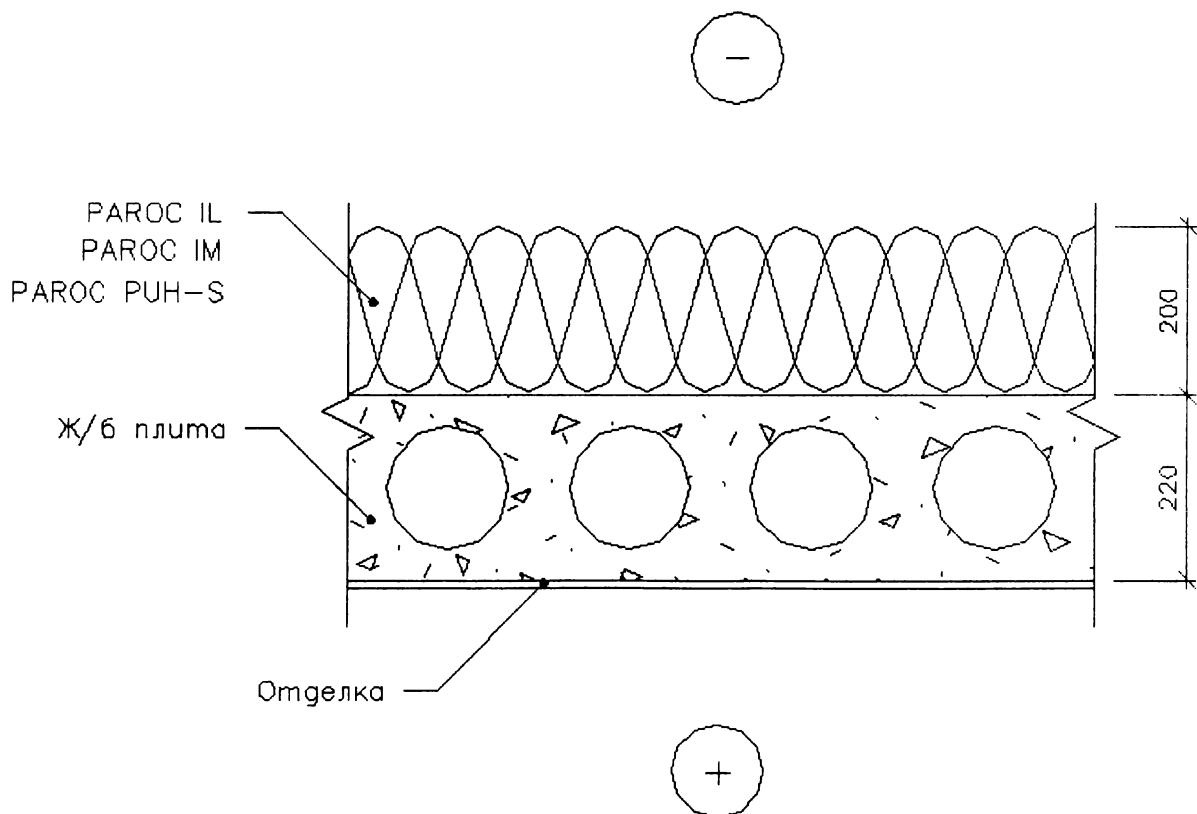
Утепление перекрытия при холодной мансарде
